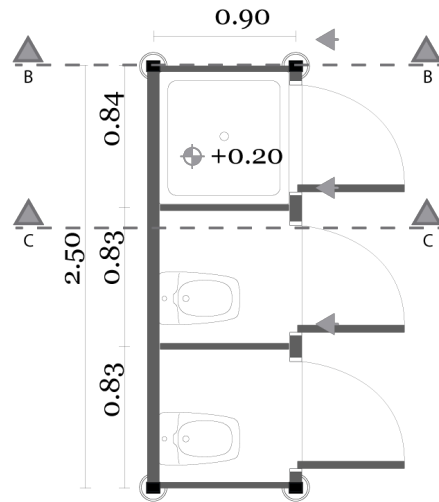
Planta arquitectónica módulo aseo Cmax System. Elaboración: Los Autores.
